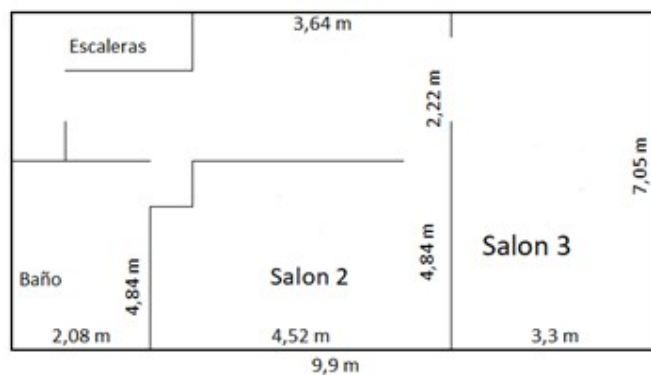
Layout segunda planta, tercer piso. Elaboración propia (2019).
